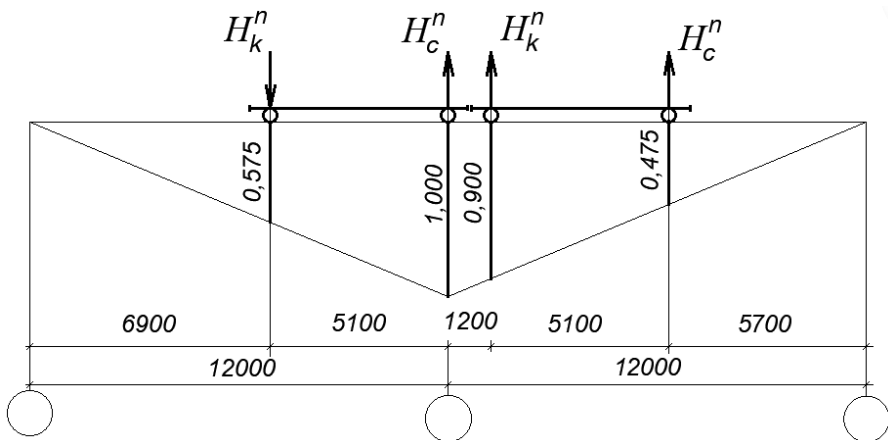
Схема для визначення горизонтальних кранових бічних навантажень від двох зближених кранів на середню опору за другим рекомендованим варіантом для правої сторони крана
